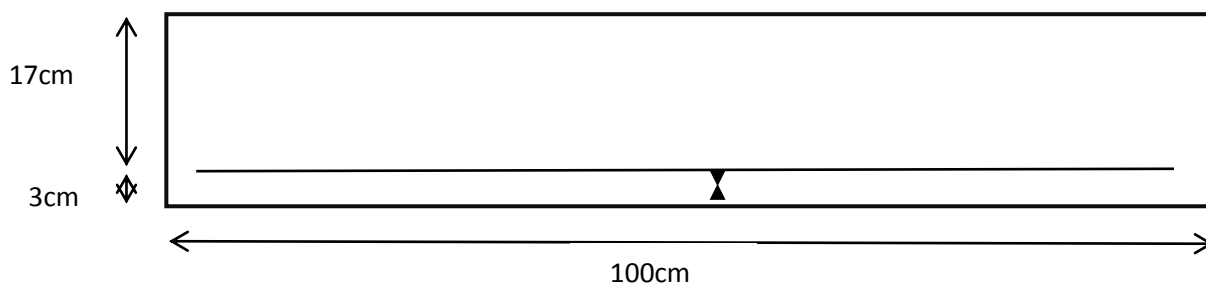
Schéma statique du ferrailage de mur plaque
